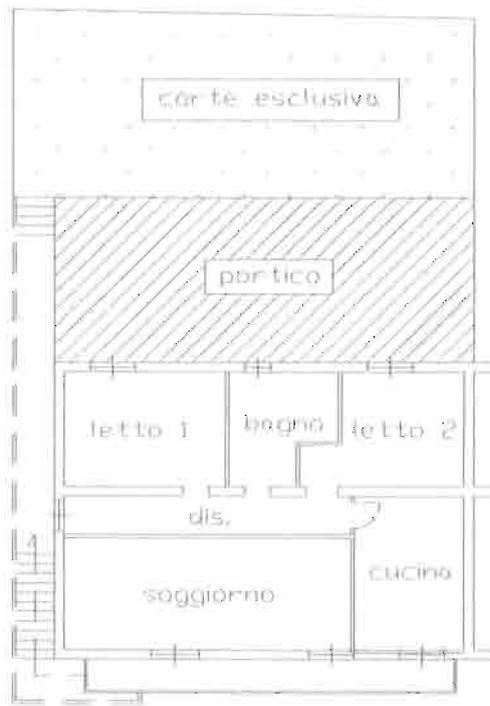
RILIEVO PLANIMETRICO (ANTE-OPERAM)
